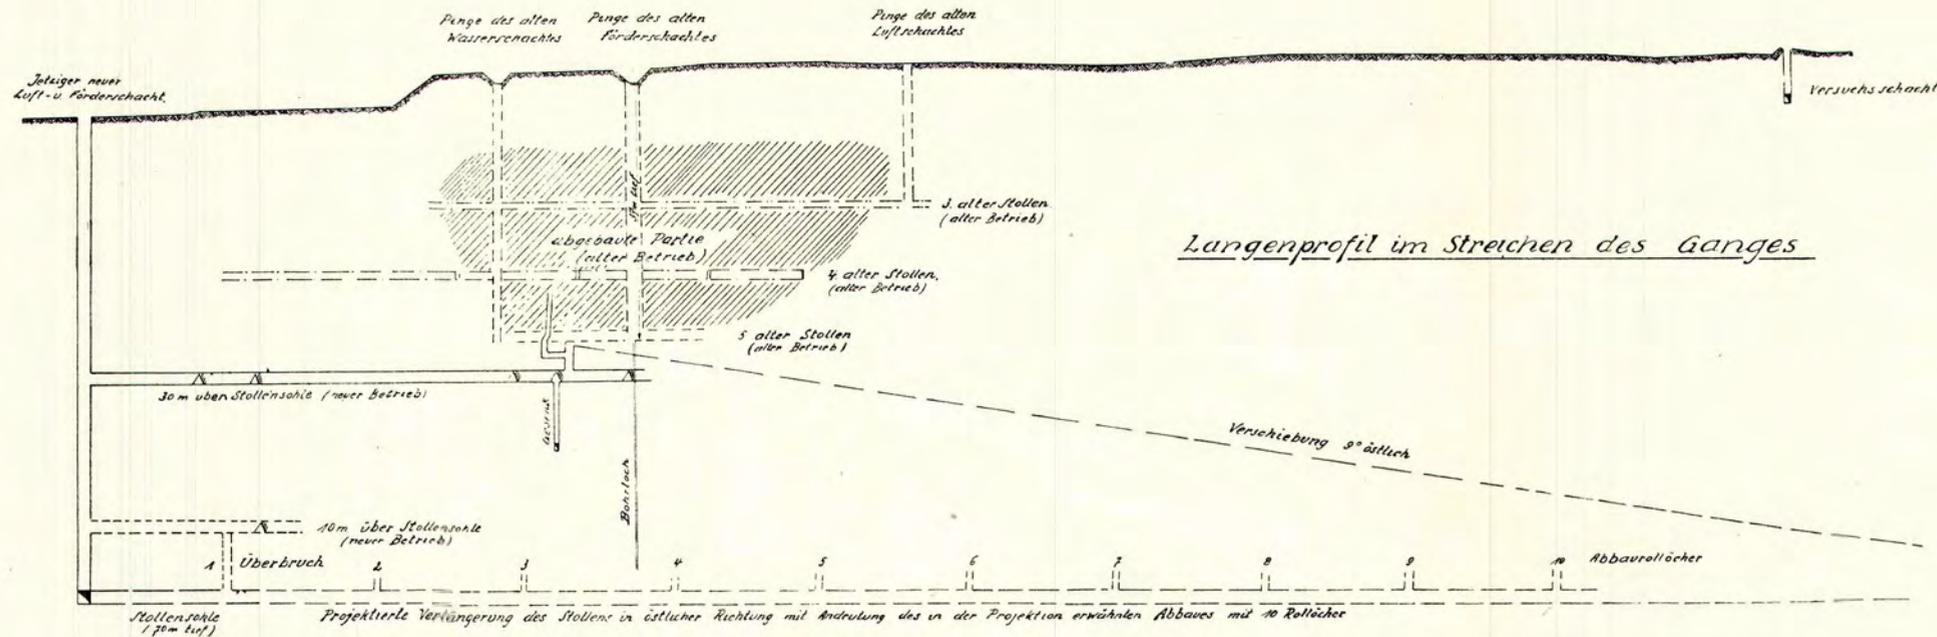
Plan und Saigerriss der Grube von Gæsdorf.
